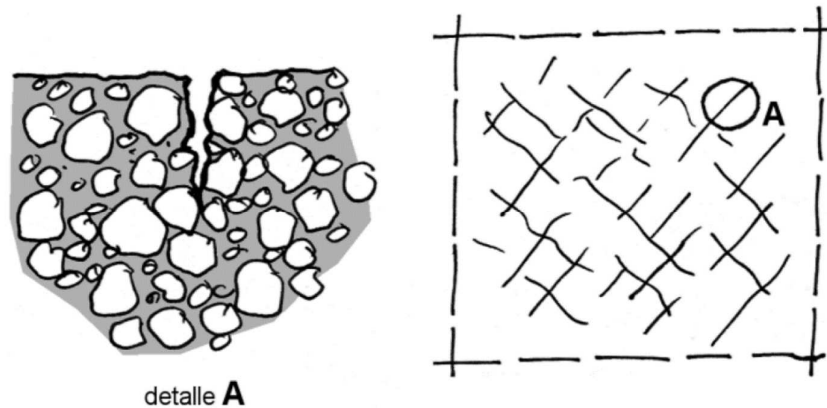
Detalle de afogado, fisuración en mapa (Fuente, MPE)
